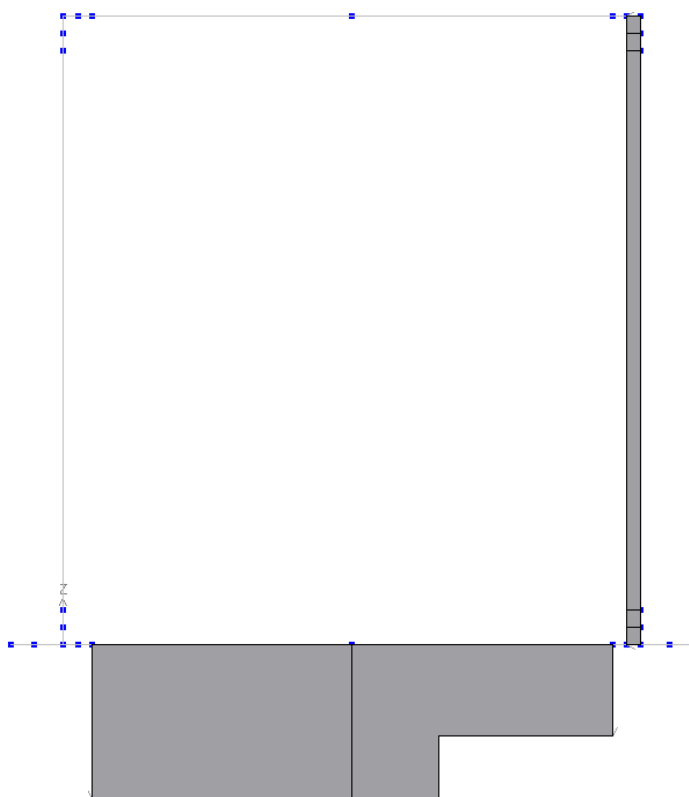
SPINTA DEL SOVRACCARICO 20 kN/M² SUL PIEDRITTO DESTRO E SOVRACCARICO ACCIDENTALE SULLA SOLETTA DI FONDAZIONE (CDC 13)
